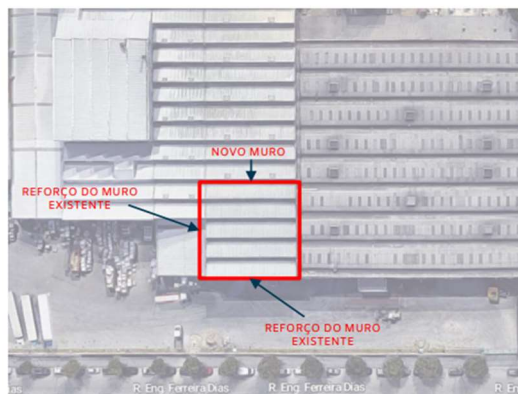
Esquema da solução proposta para renovação da Fachada Este (Eleven Steps, 2023)
